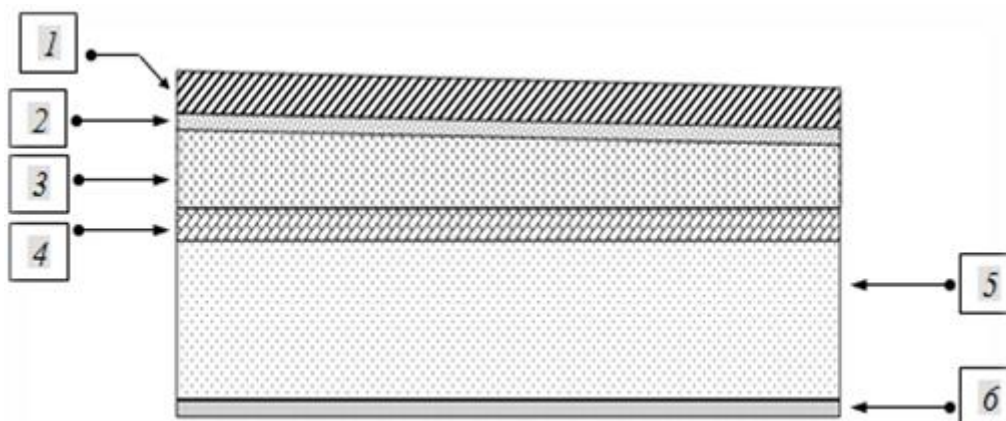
Coupe verticale du plancher terrasse à dalle pleine.
